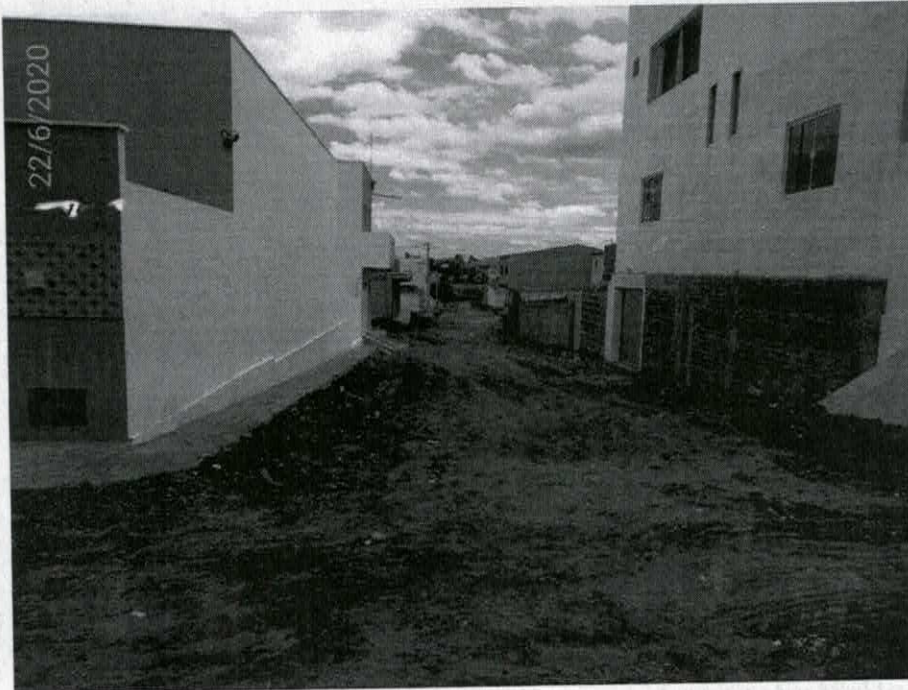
Travessa Jose Carlos de Santana - Bairro 3 a 1
